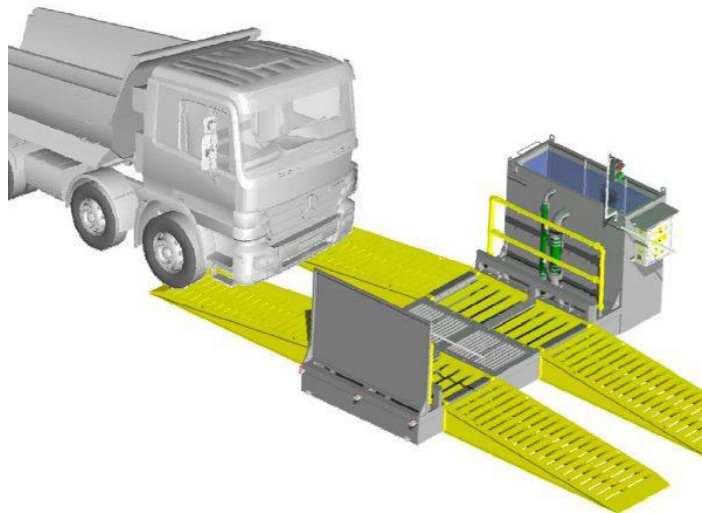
Schema tipo prefabbricato lavaggio ruote
